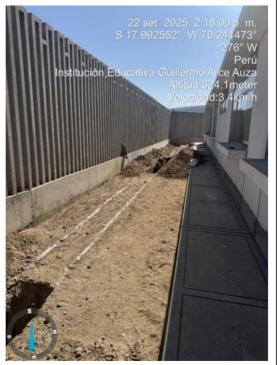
Trazo para excavación de zanja en nivel inicial
